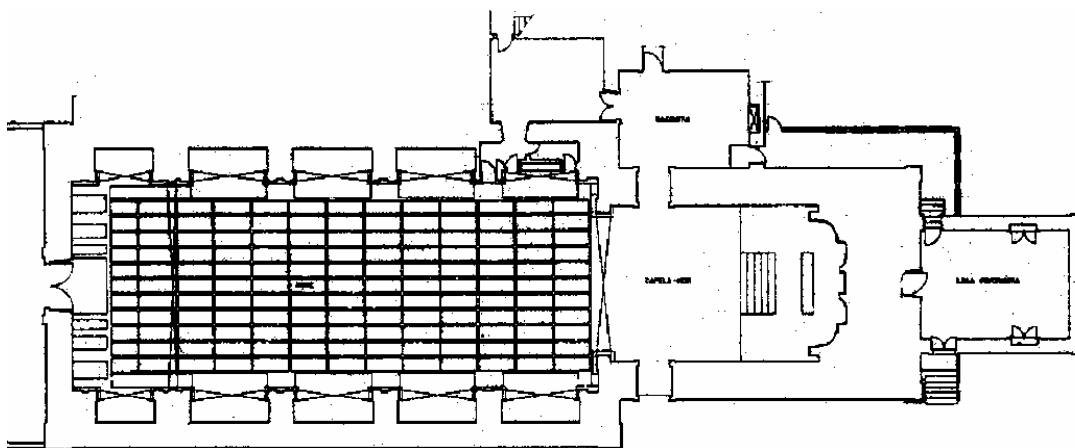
Planta da igreja de São João Baptista (Porto) [3]
